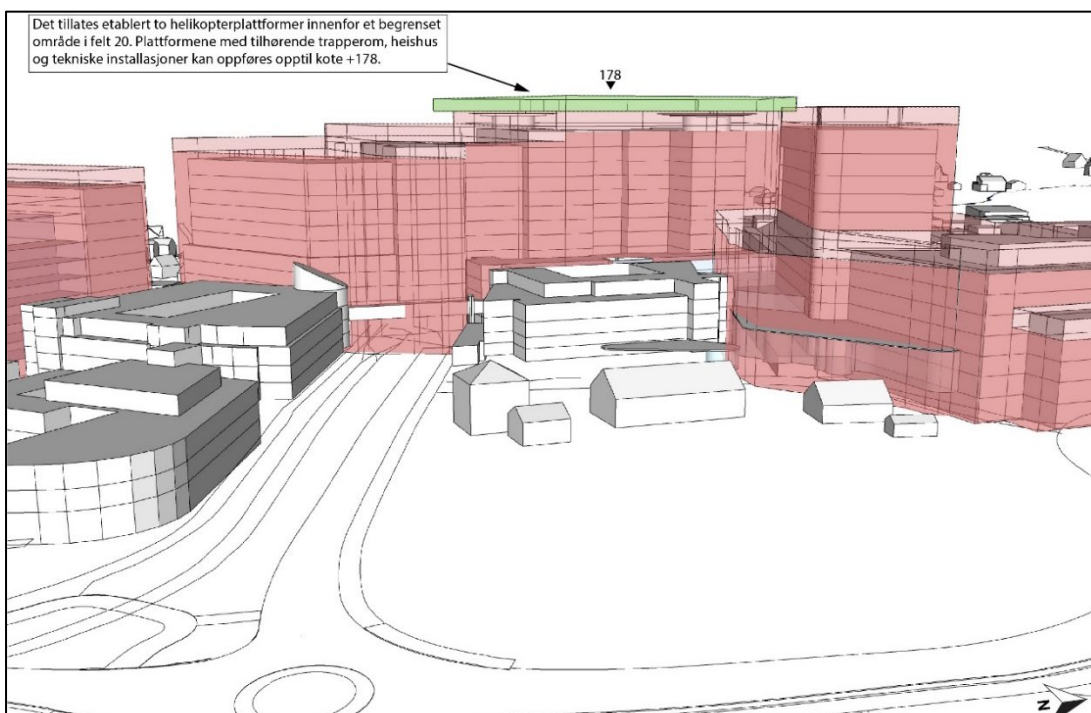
Planforslaget sett fra nord-øst. Planområdet er markert med rød stiplet linje.
